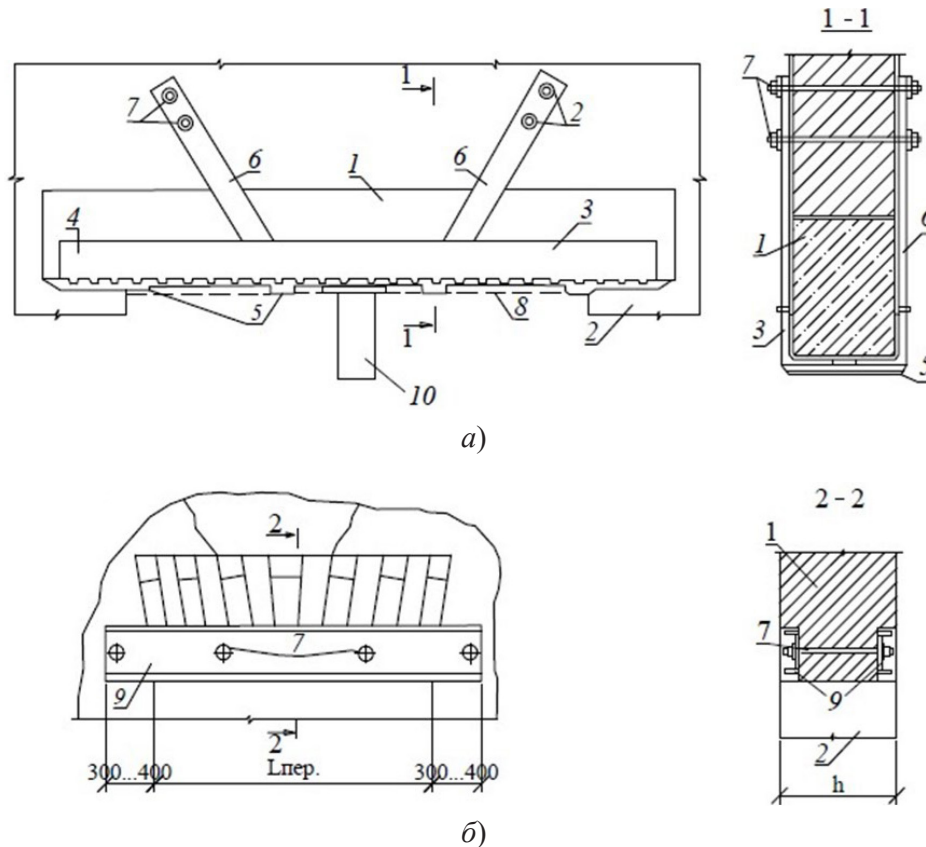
Усиление перемычек подведением разгружающих балок:
